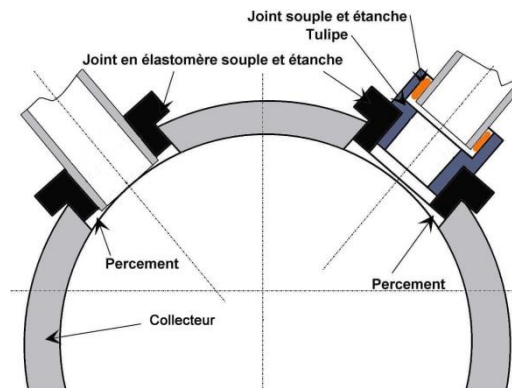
Exemples de raccordement par joint en élastomère avec et sans tulipe
